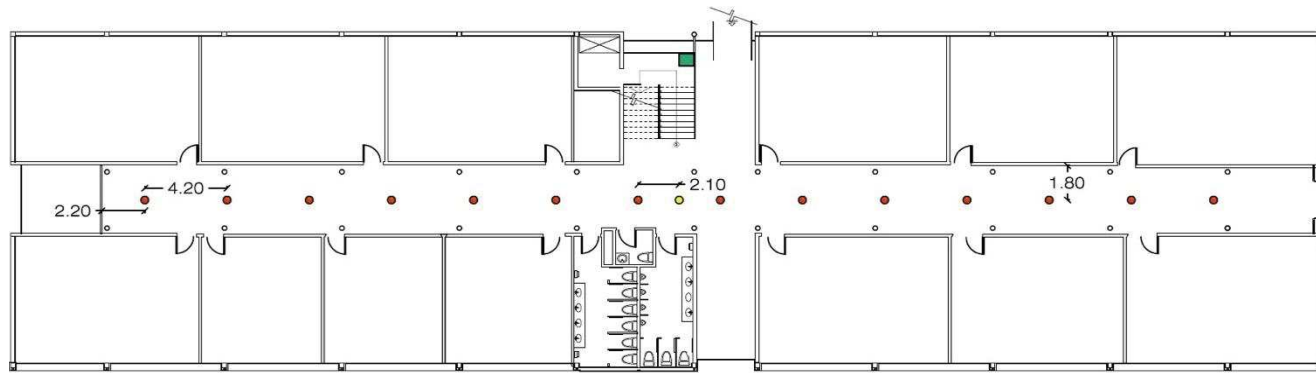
Altavoces y micrófono en el Bloque 1. Planta Baja.
